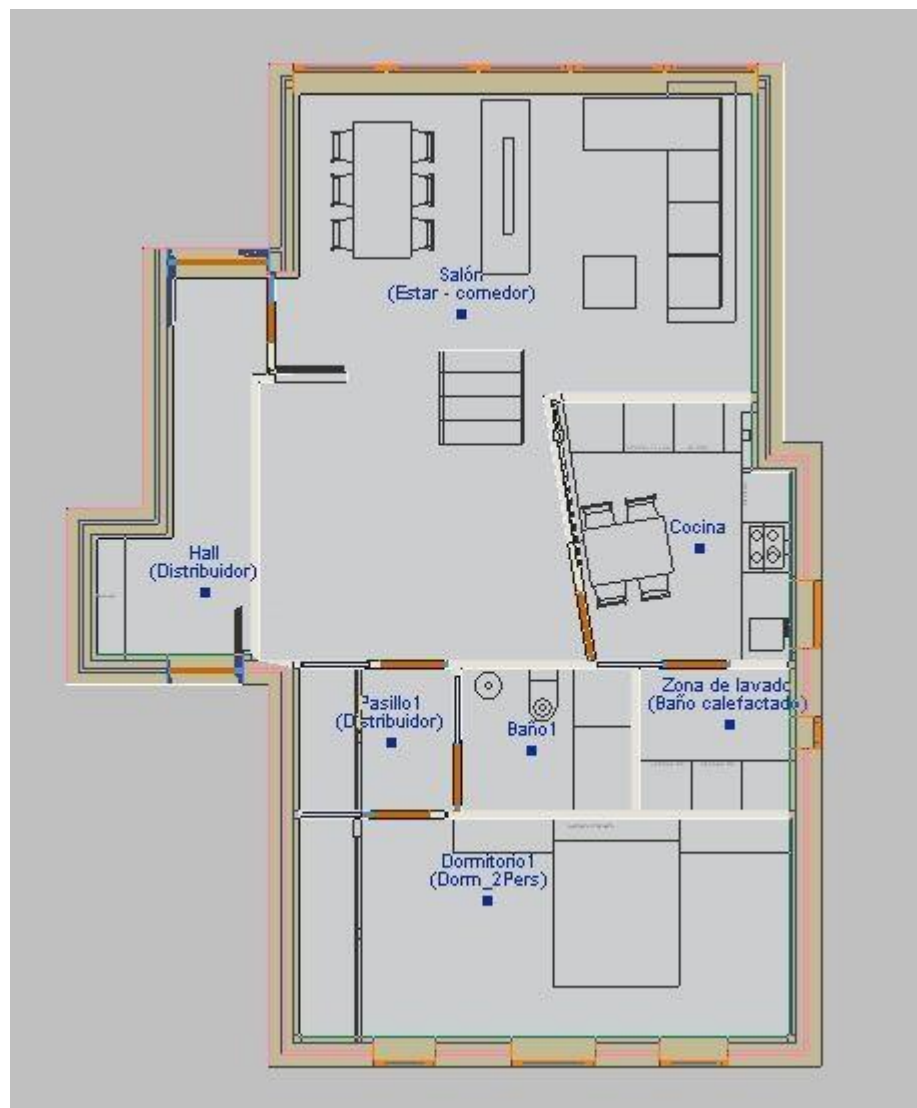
Distribución de los espacios de la vivienda en la planta baja.
